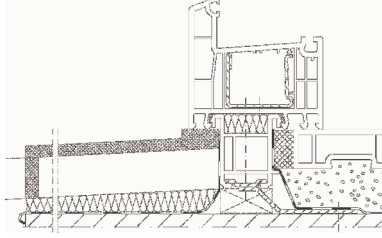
Utěsnění v oblasti bočního napojení okenního parapetu - příklady detailu
